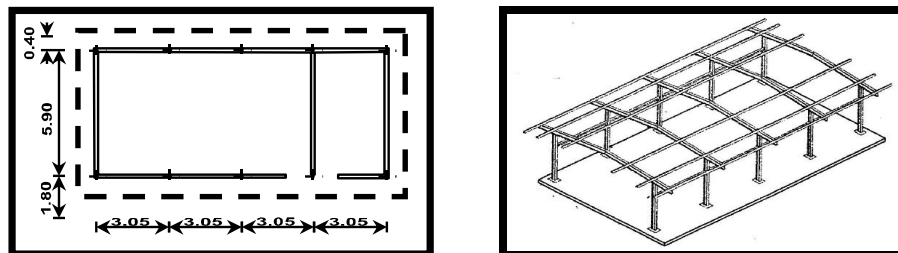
Escuelas Tipo R Tradicional. Fuente: Manual de FEDE.
